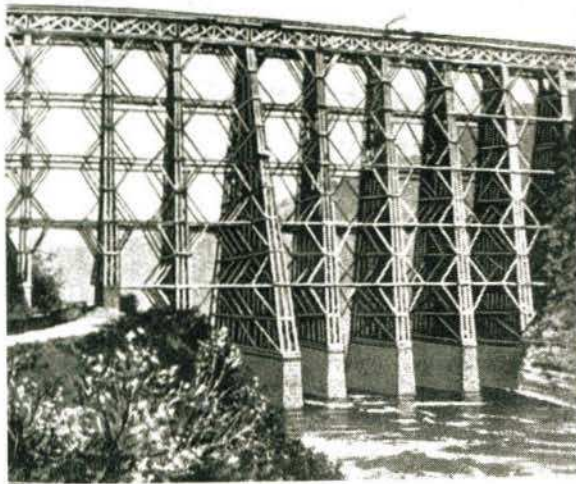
Holzgerüste als Unterbau in Amerika (trestle works)
